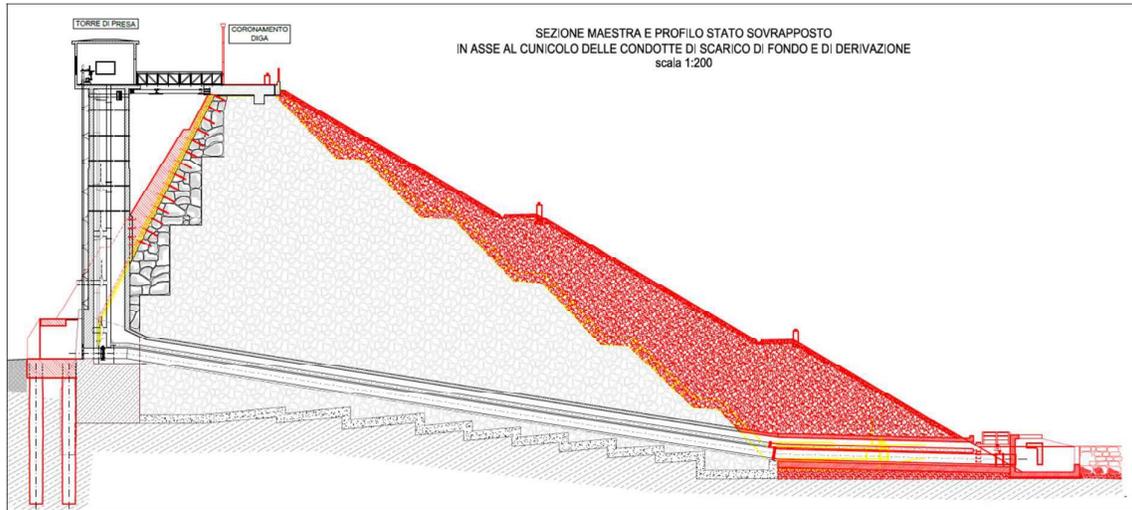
Stato sovrapposto – Sezione maestra – In rosso gli interventi in progetto
